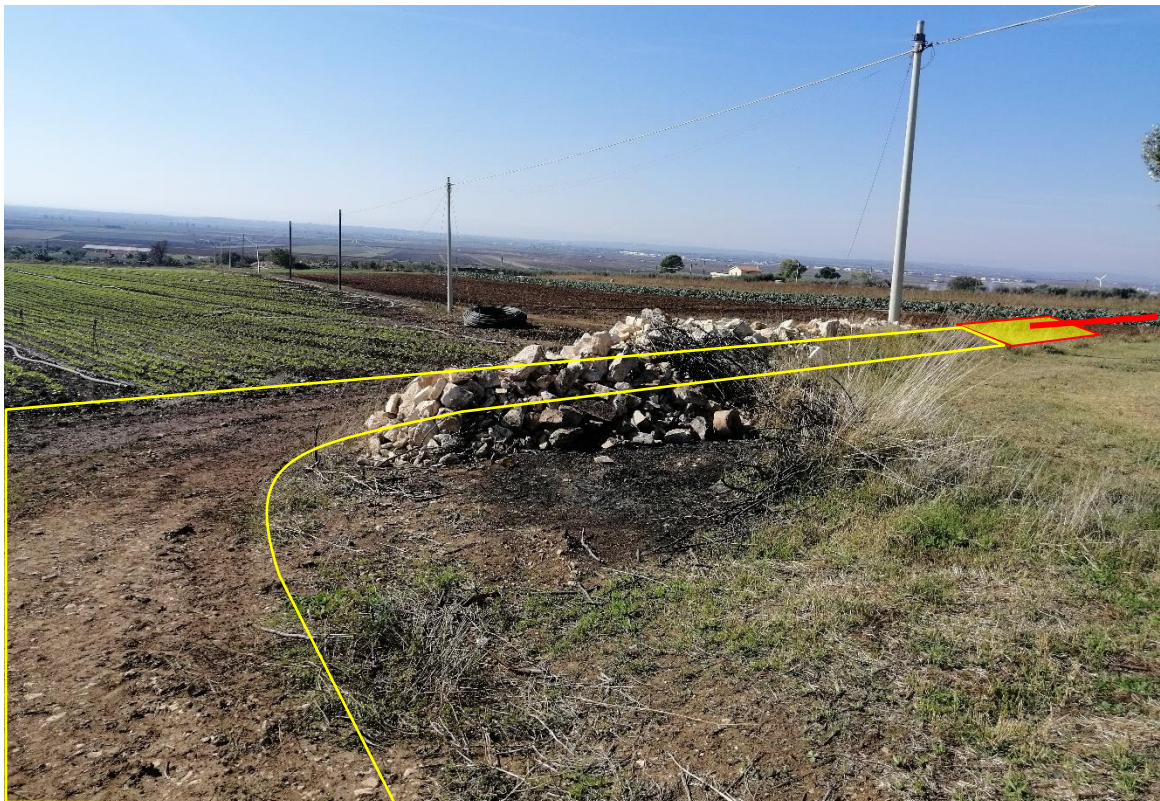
Impianto finale PIDA n°4 e strada di accesso
